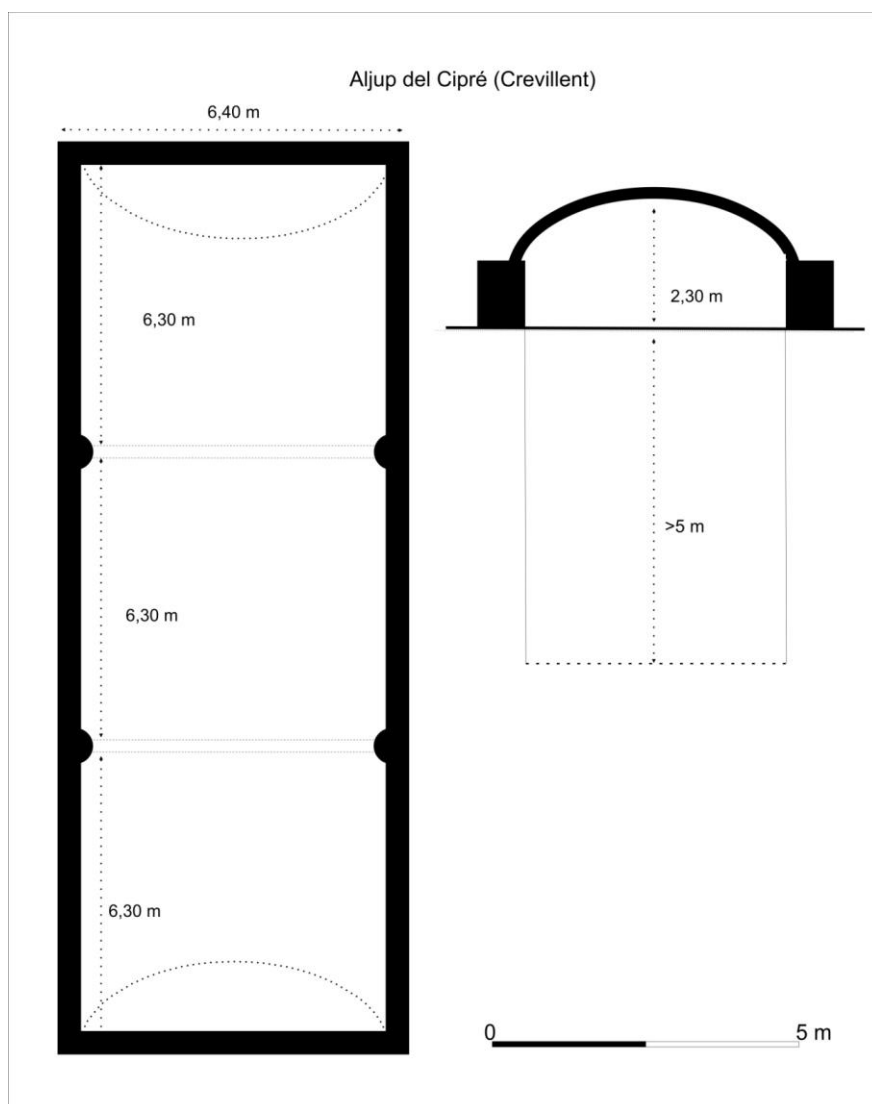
Aljibe del Cipré. Croquis de la planta y sección.
